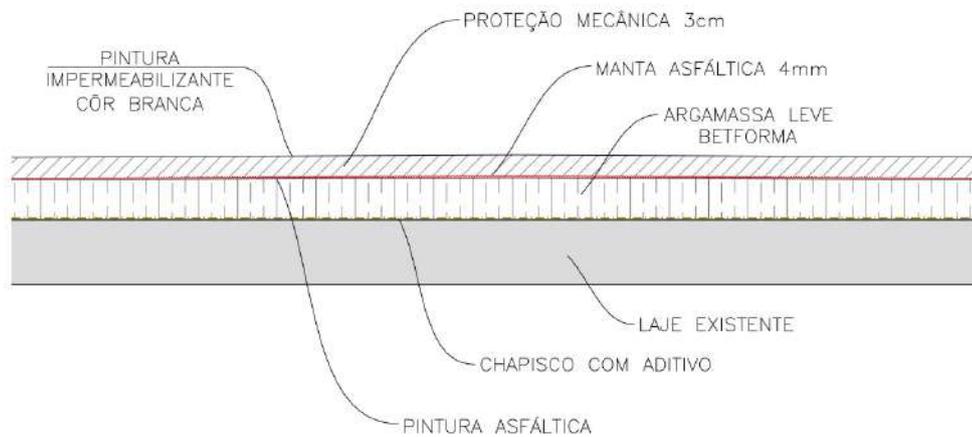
Croquis da impermeabilização, para reconstituição da laje plana.
